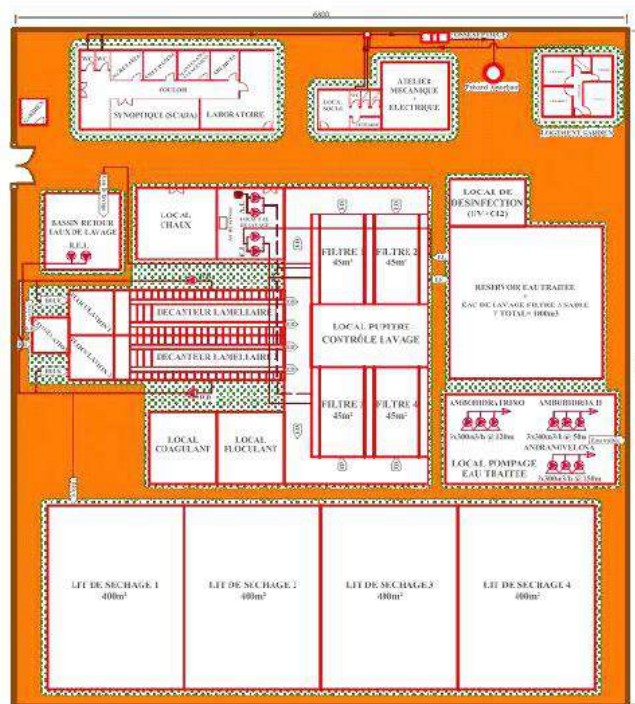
Plan de masse d'une station de traitement type (d'après rapport APS avril 2019)
